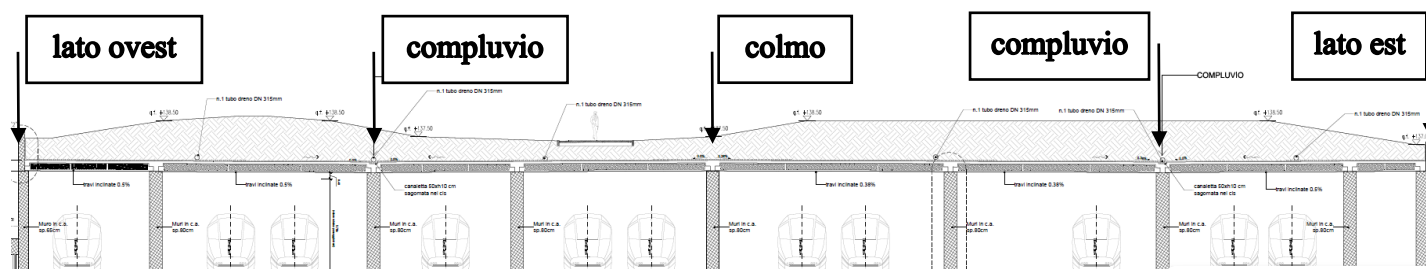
Sezione trasversale della piastra verde lungo la direttrice di raccolta est-ovest
